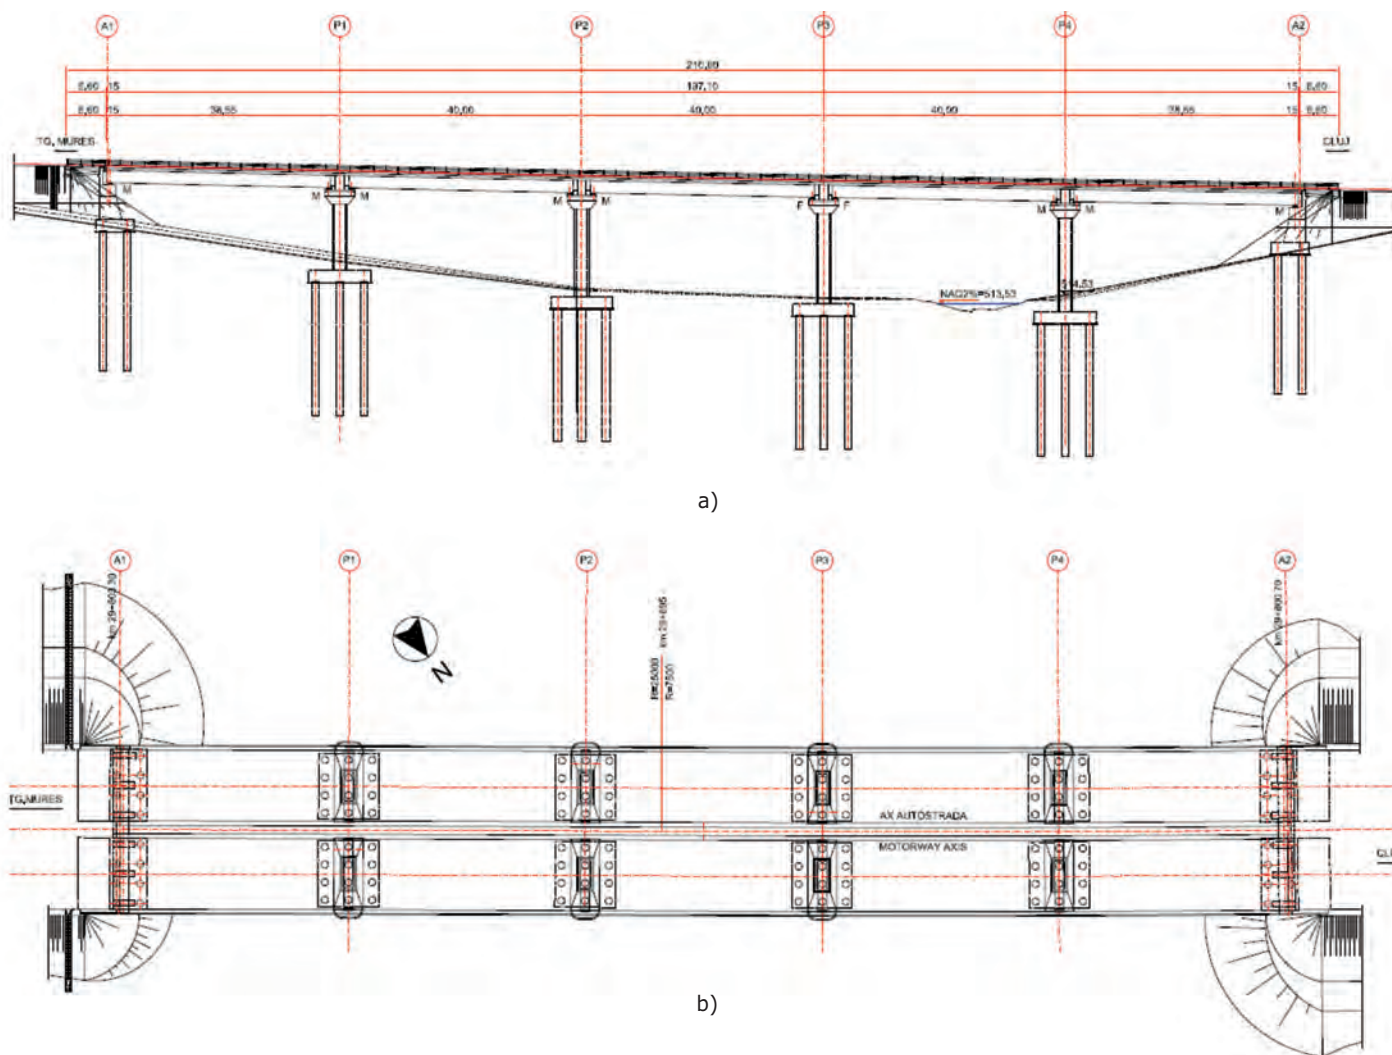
Dispoziție generală a podului: a) Elevație; b) Vedere în plan
